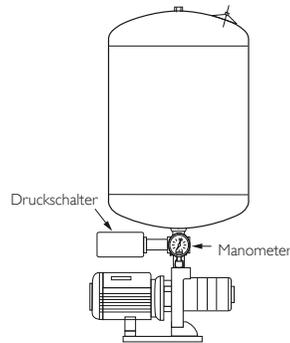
Kompressorpumpe mit eingebundenem Behälter
